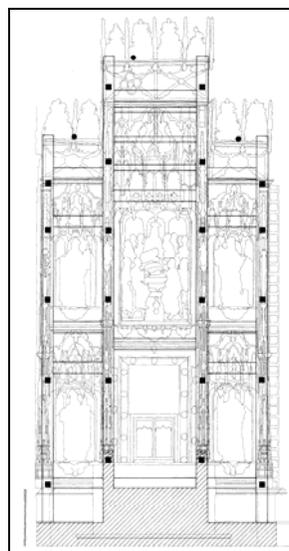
Levantamiento planimétrico y definición de elementos estructurales. Retablo del Sagrario de la Iglesia de San Juan Bautista de Marchena. Sevilla.
